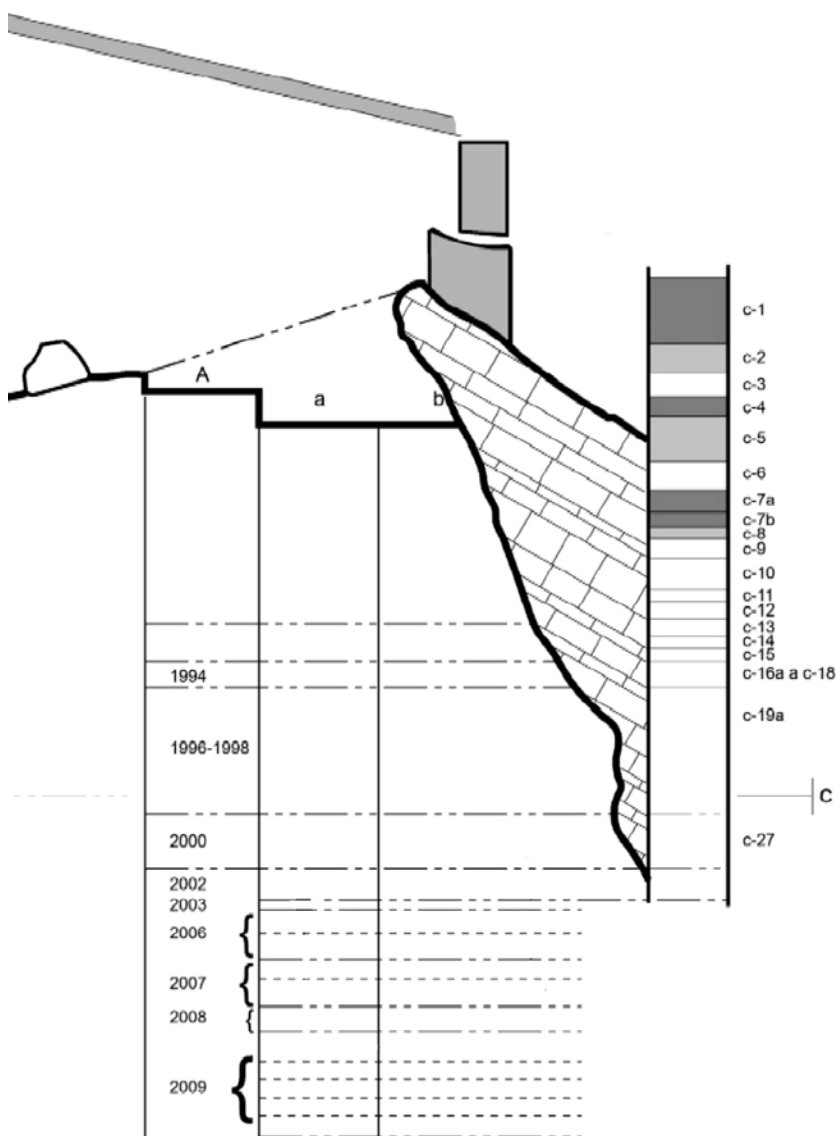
Detalle del corte longitudinal del relleno en el que se indican las capas excavadas (Aparicio, 2014).
